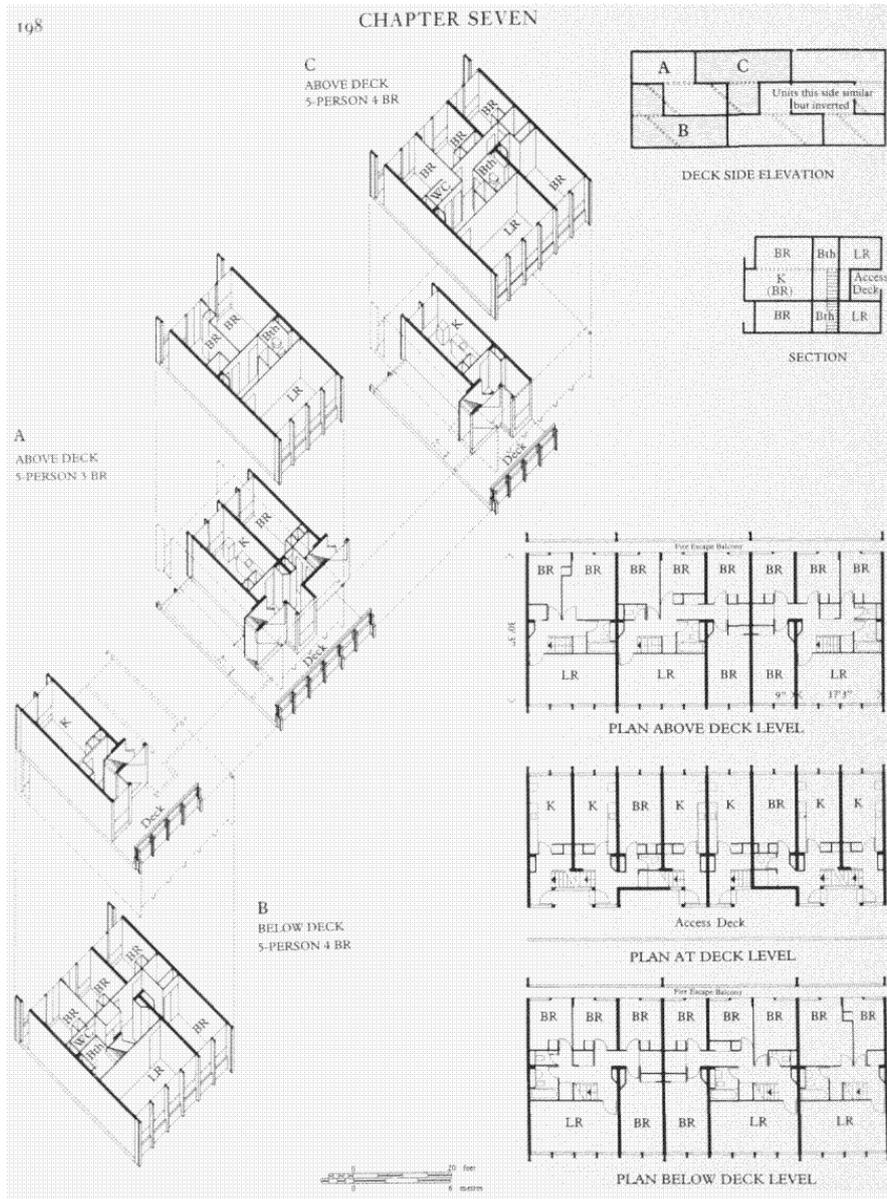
Plantas y axonometrías de viviendas tipo del proyecto Robin Hood Gardens. 1959. Fuente: Survey of London: Volumes 43 and 44, Poplar, Blackwall and Isle of Dogs vía www.british-history.ac.uk
